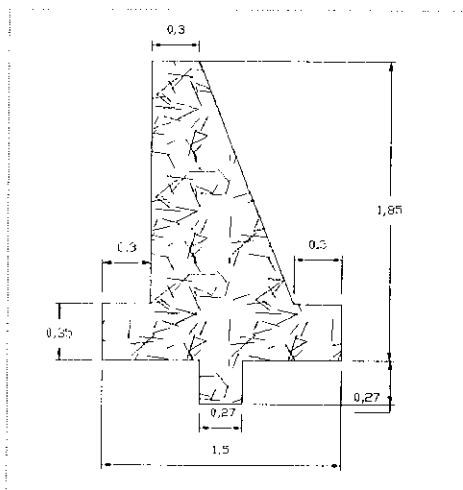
Sección Típica Muro en Concreto Ciclopéo
